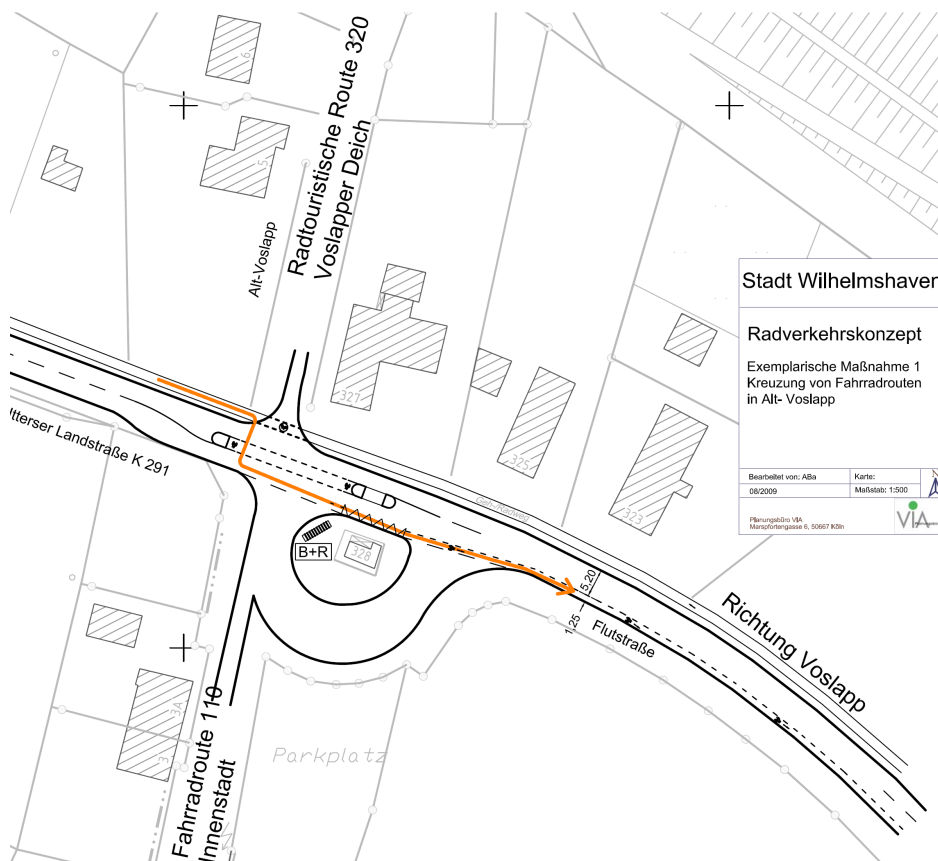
Lageplan zur Maßnahme Alt-Voslapp
